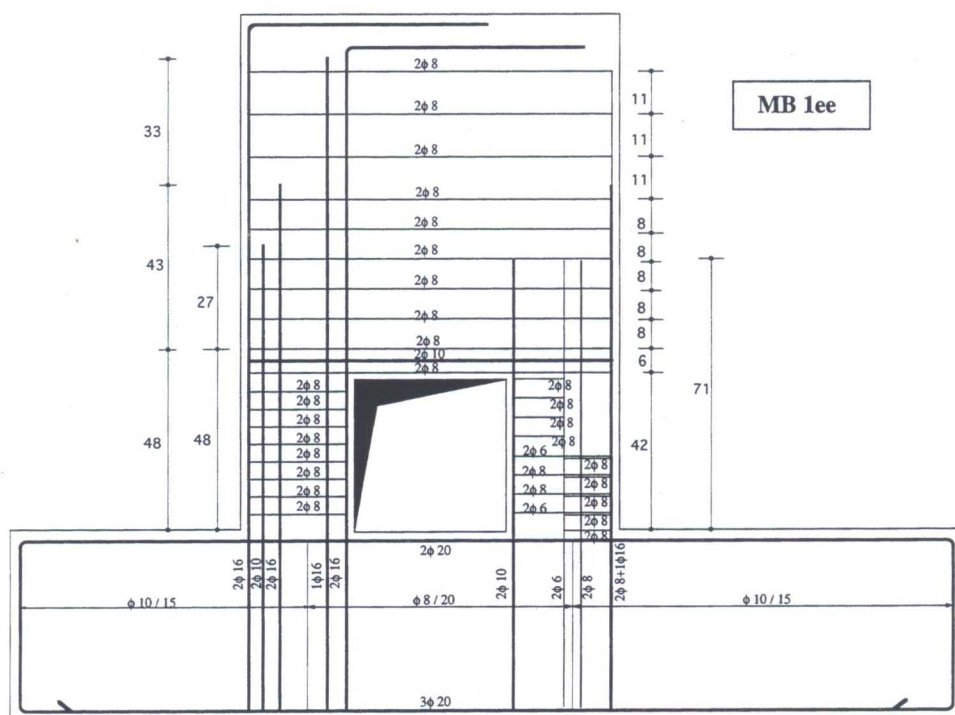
Pormenorização das armaduras do modelo MB1ee-EXP, adaptado [10]
